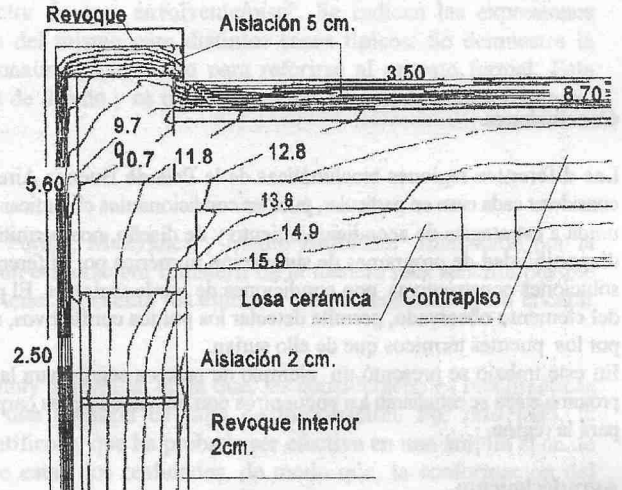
Encuentro muro / losa, con aislación exterior s/c.
